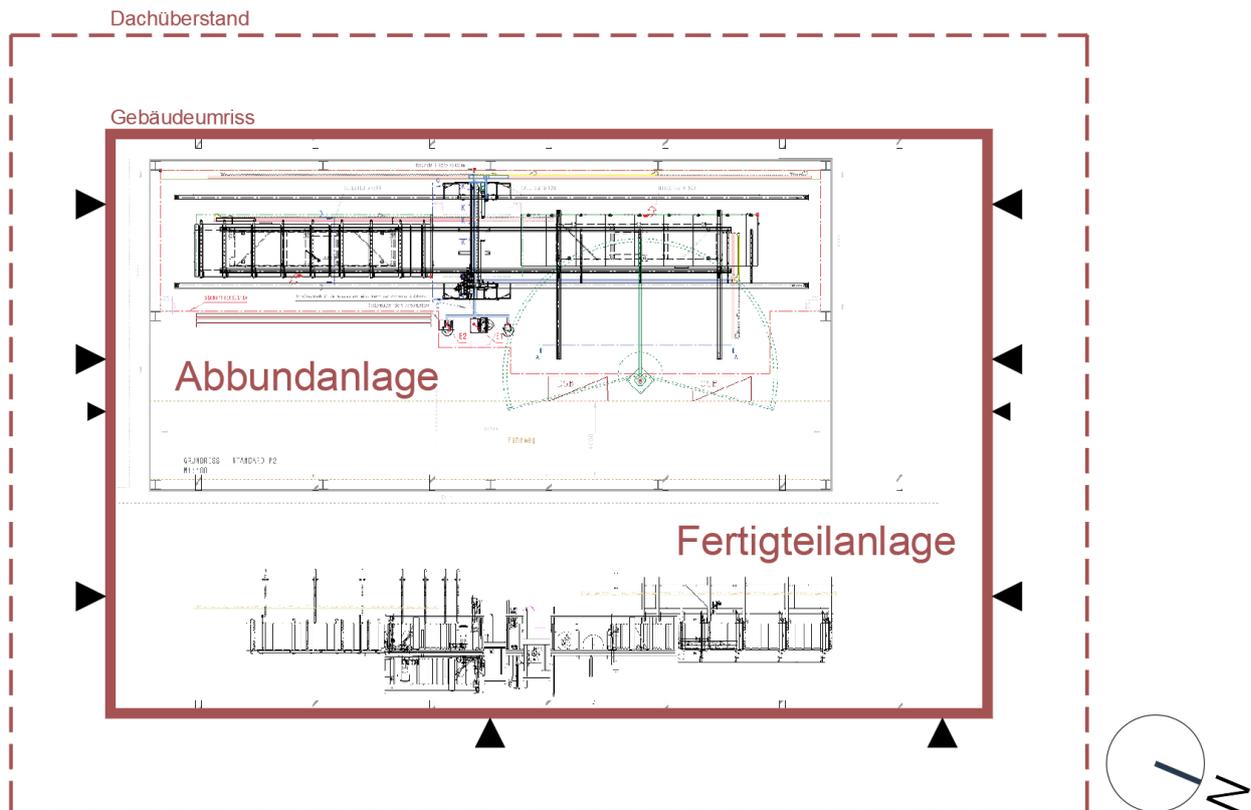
Planungsstand Bauvorhaben Produktionshalle mit reduzierter Grundfläche (30x45 m): Schema / Flächenbedarf betriebliche Abläufe
